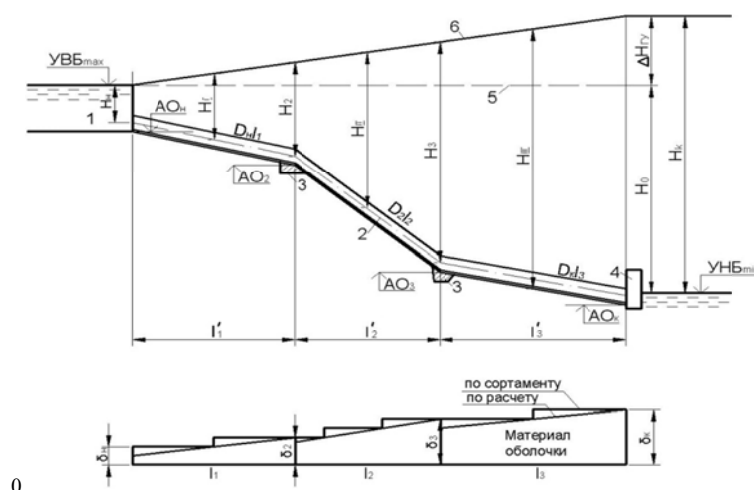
Расчетная схема определения диаметра и толщины оболочки стального трубопровода: 1 – напорный бассейн; 2 – ось трубопровода; 3 – анкерная опора; 4 – здание ГЭС; 5 – гидростатический уровень; 6 – эпюра повышения напора при гидравлическом ударе
